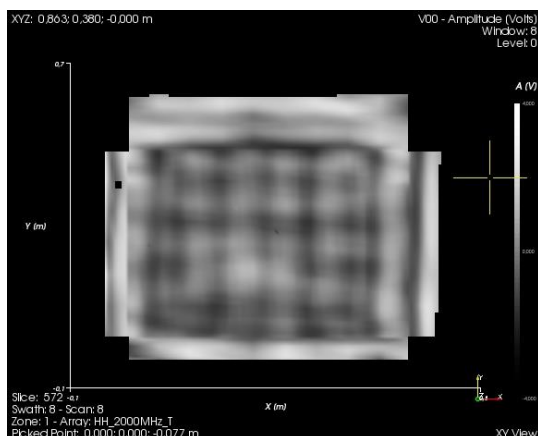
Řez deskou v hloubce 45 mm po výpalu
